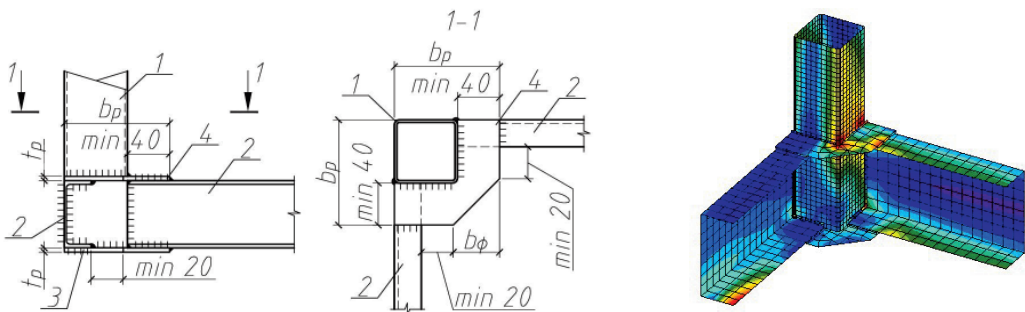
Схема и МКЭ модель узла с горизонтальными ребрами (Тр-Шв-ГР).
